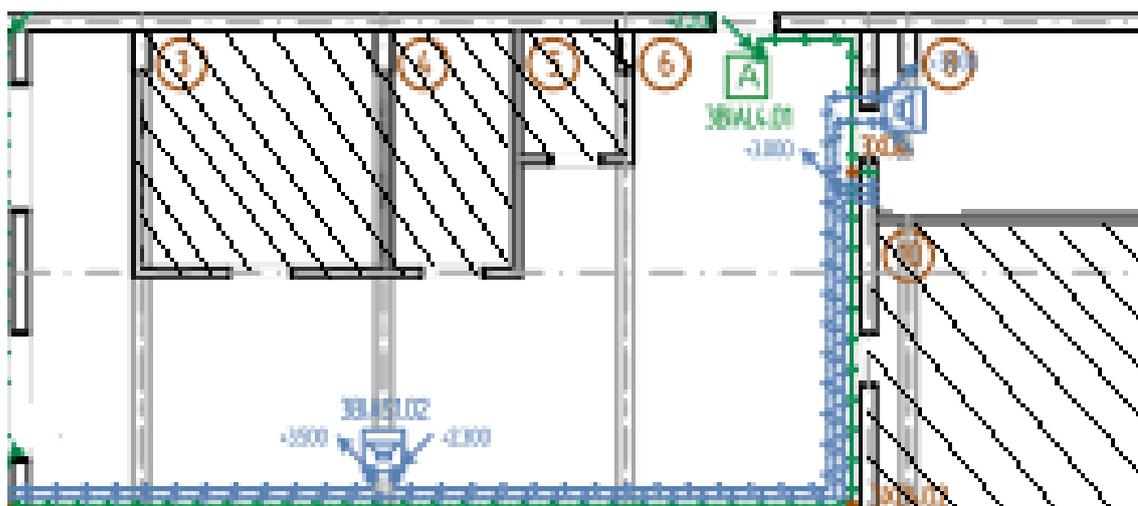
Расположение звуковых и световых оповещателей в коридоре
